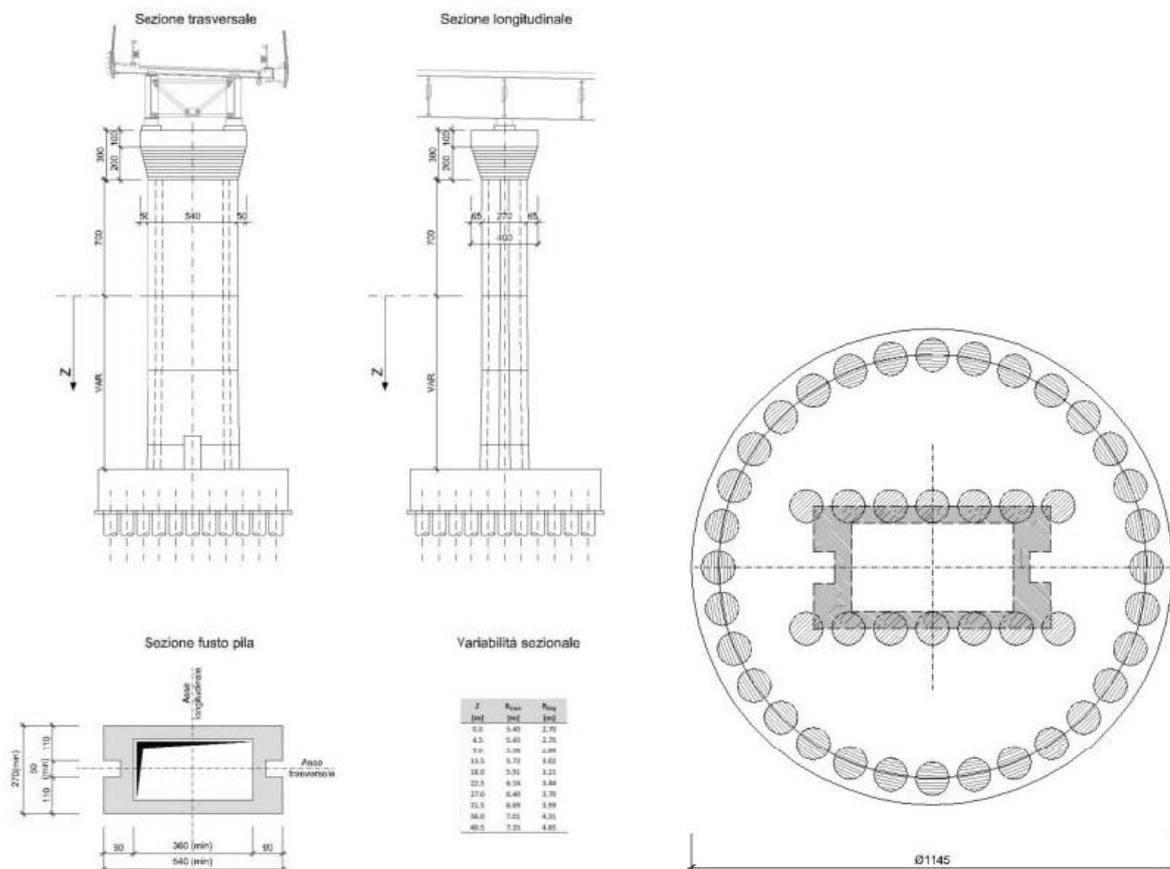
Inquadramento generale geometria pile e fondazioni Viadotto B
